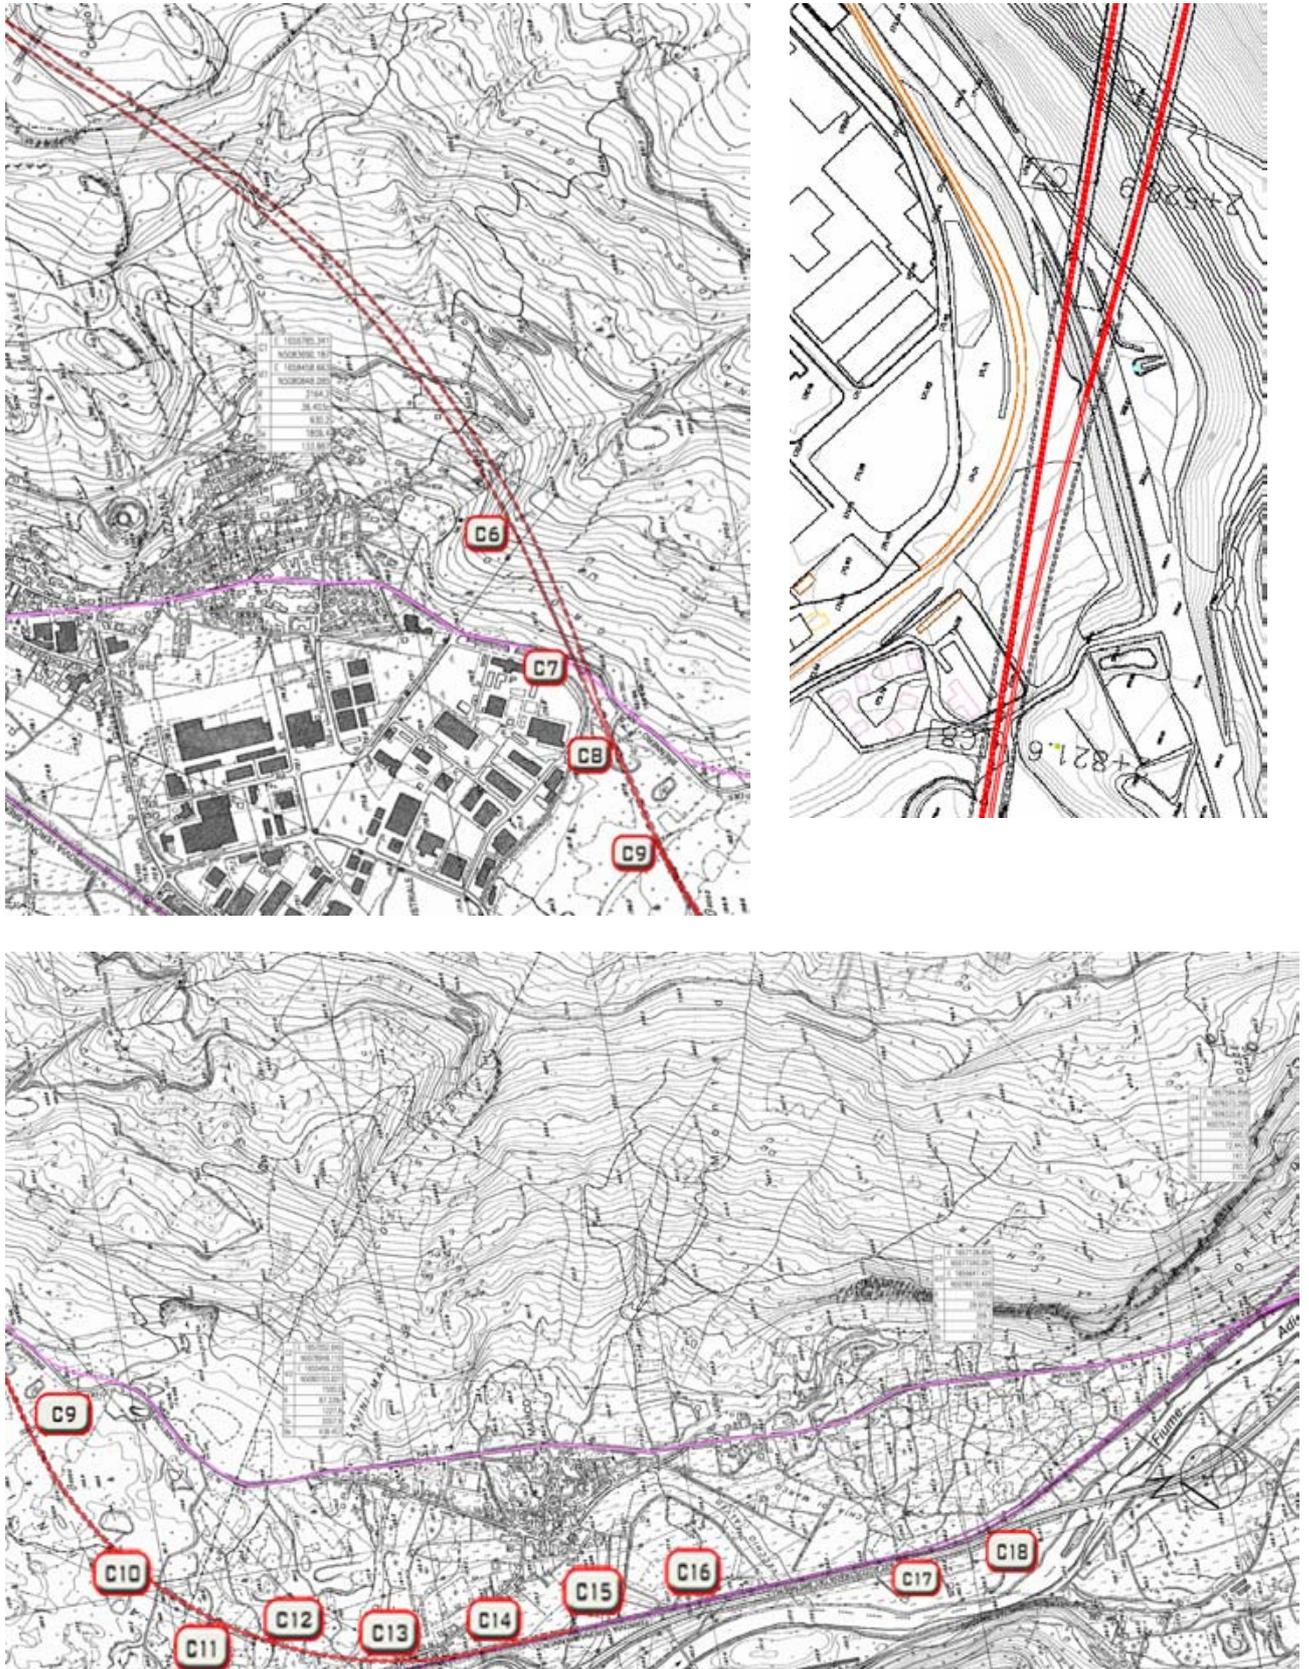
Planimetria della variante C del progetto preliminare secondo la versione di maggio 2008.
